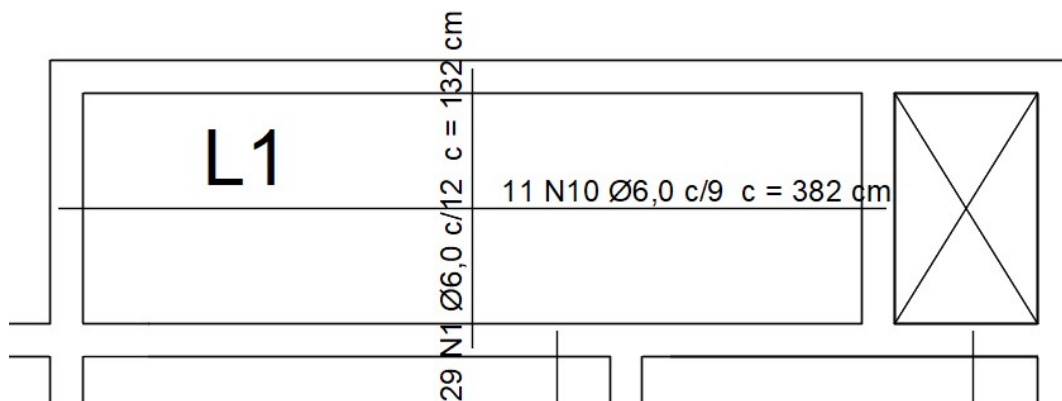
Croqui da armadura positiva e de retração e temperatura laje L1
